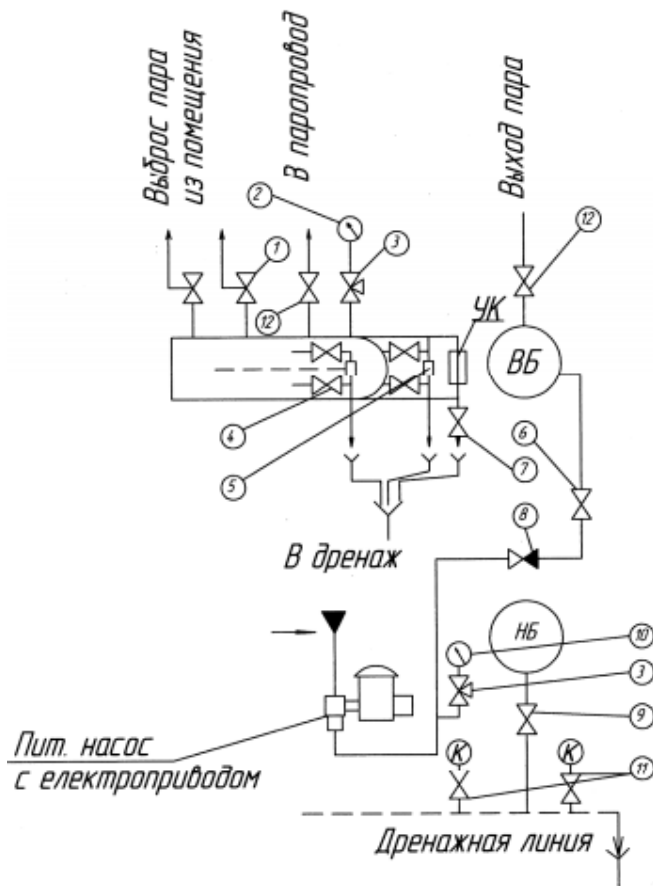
Схема трубопроводов котла Е-1.0-0.9Г
